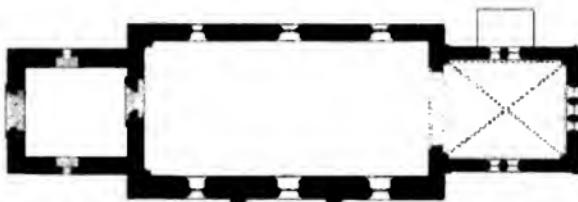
Grundriss der Kirche zu Grönau. 1. ^{1/20.}
